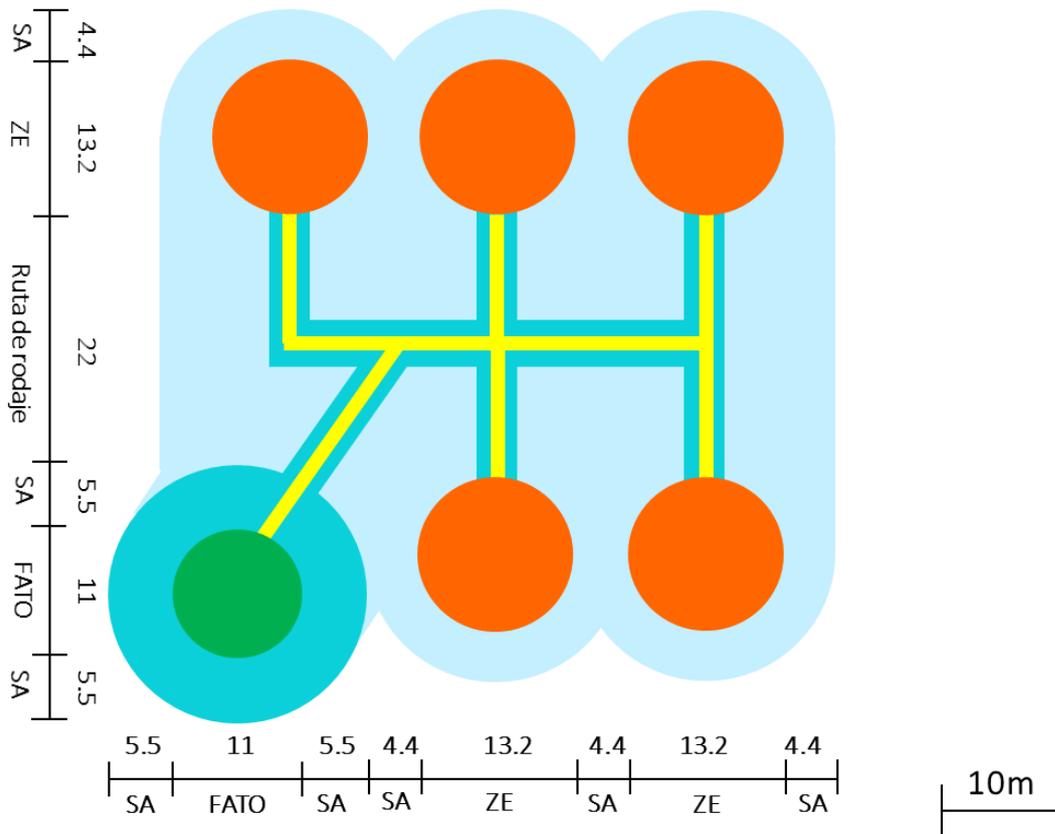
Plano dimensionado de la pista en configuración racimo. Fuente: elaboración propia
